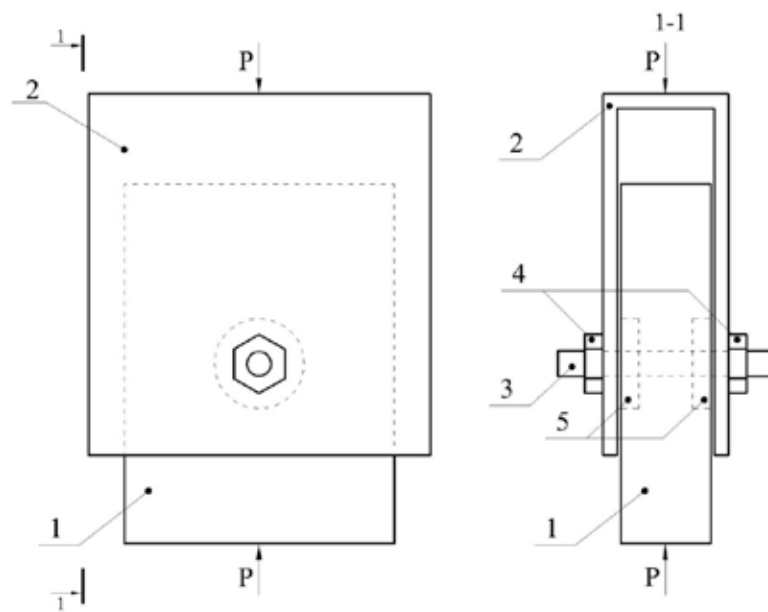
Схема нагружения образца при помощи металлических накладок: 1 — деревянный элемент; 2 — металлическая рама; 3 — стяжной болт; 4 — гайки; 5 — вклеенные шайбы
